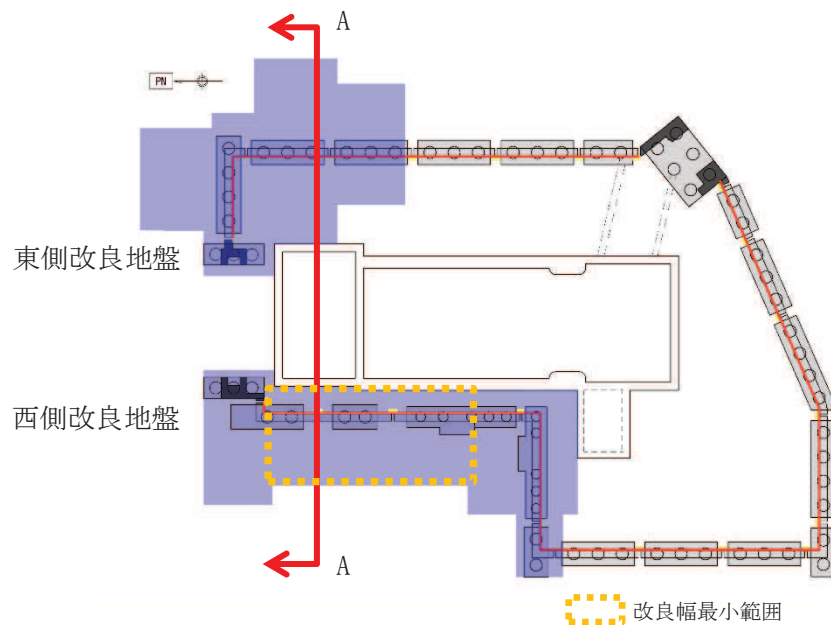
第2号機放水立坑改良地盤評価対象断面 平面図
